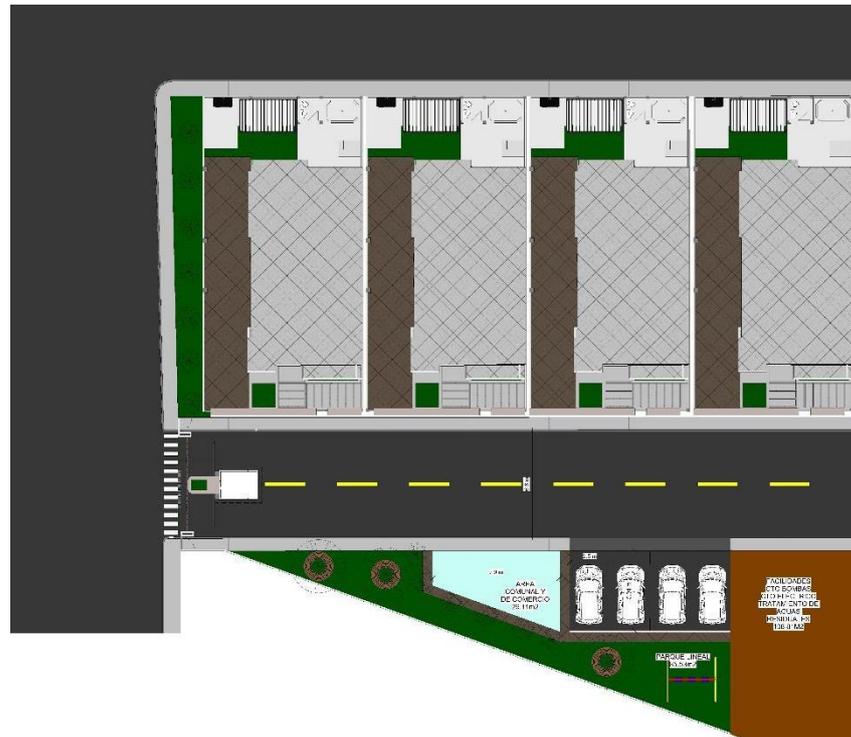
Vista en planta del plan masa de la urbanización propuesta. (Elaboración propia archivo RVT).
